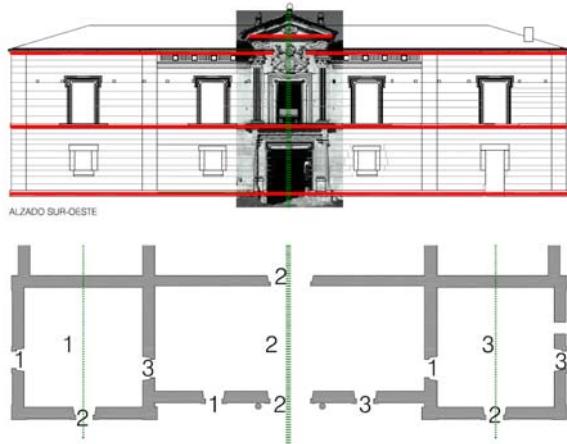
Horizontalidad del alzado; planta de la crujía Suroeste.
